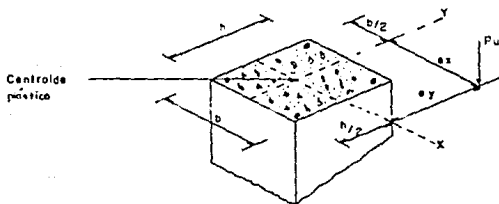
Sección de columna de concreto con flexión biaxial, reforzada simétricamente.
